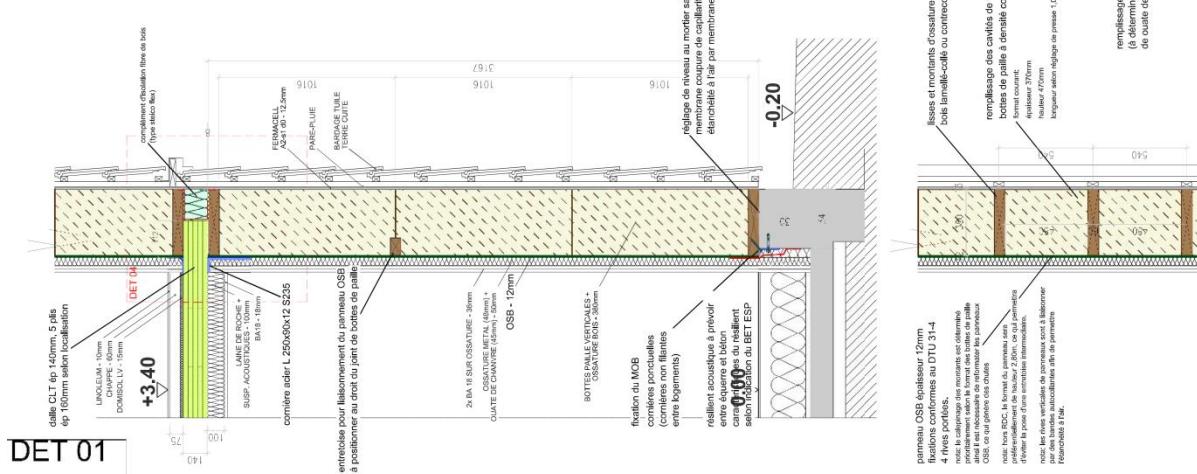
Detail Fassade (gekippt), mit Deckenanschluss
